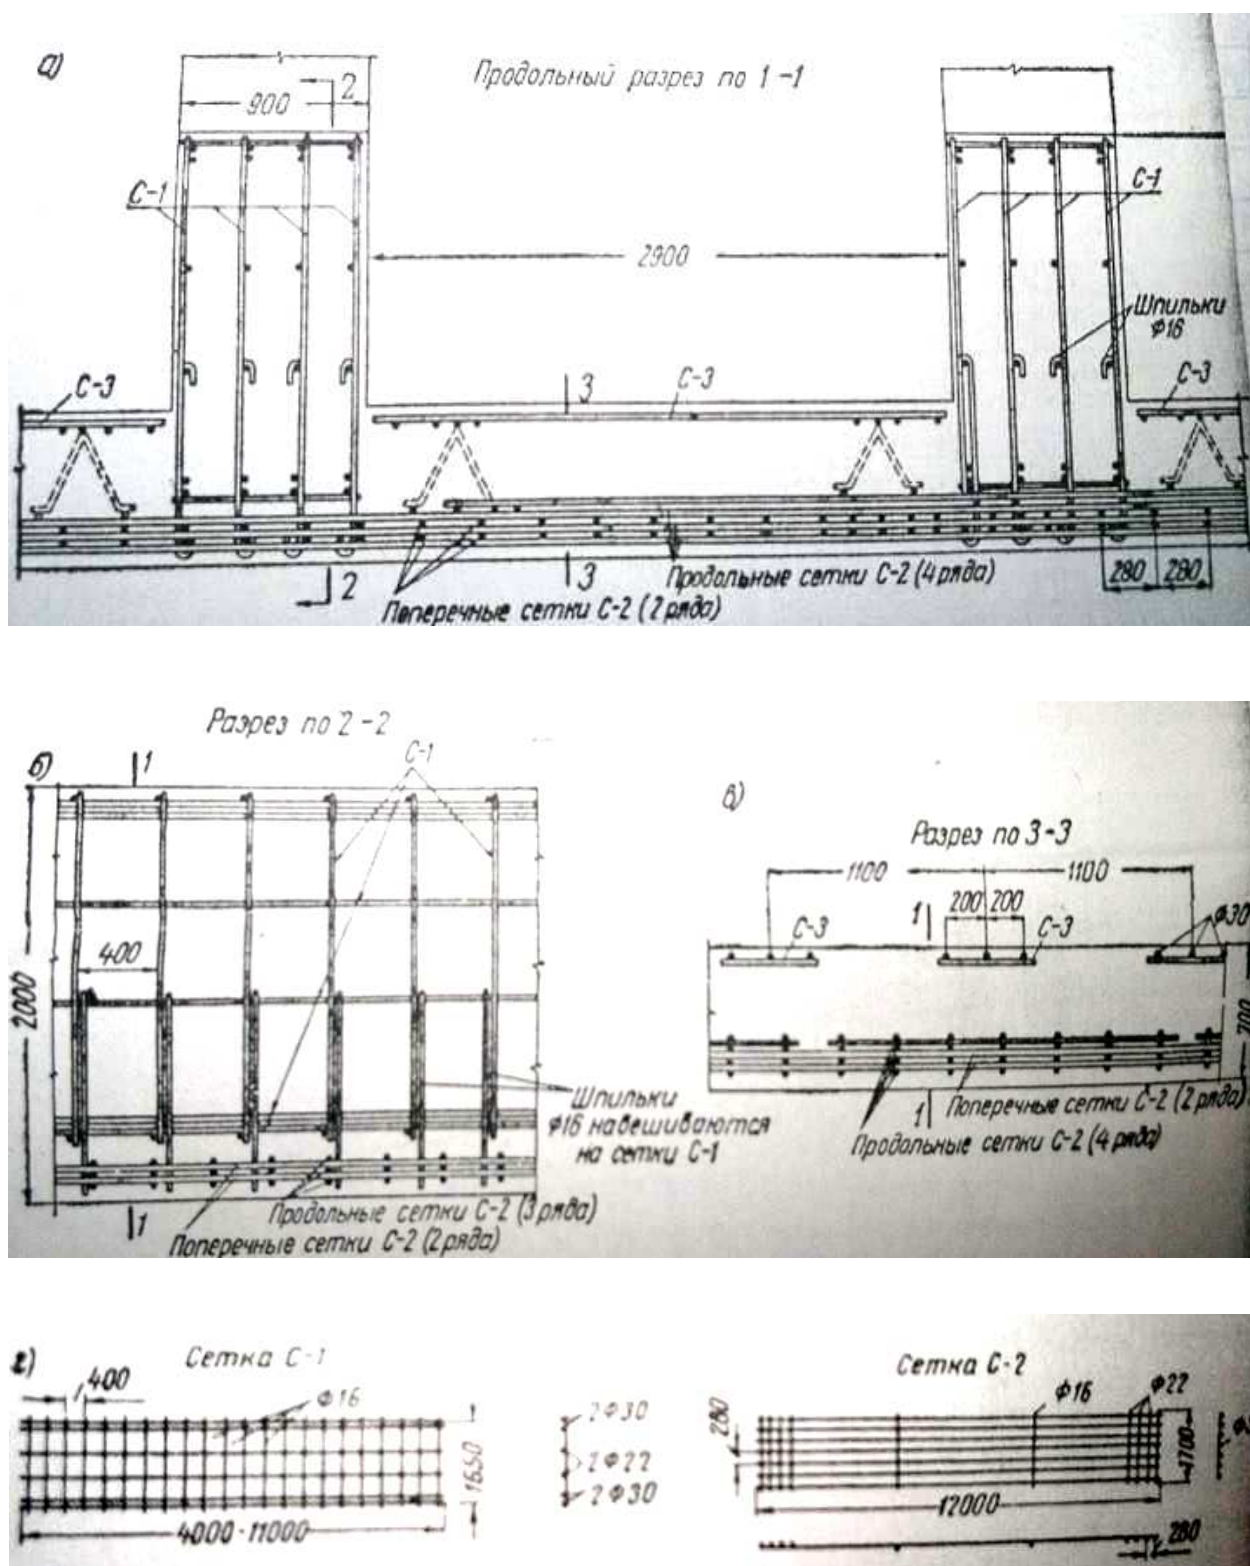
Армирование ребристой фундаментной плиты сварными сетками:
